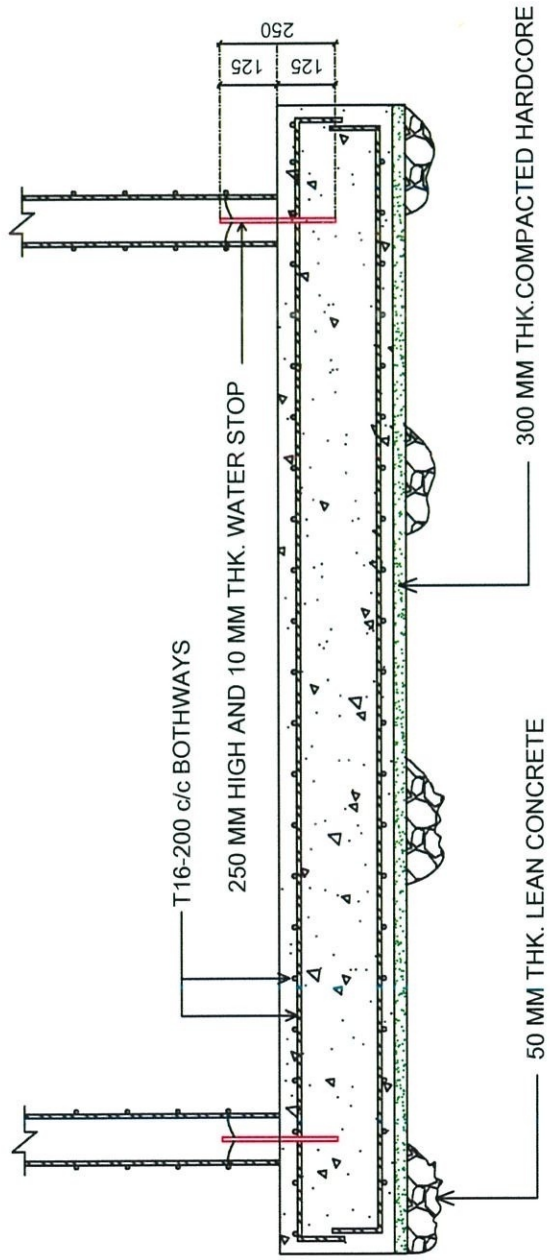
PELAN SECTION FOR SEWERAGE TREATMENT PLANTS
